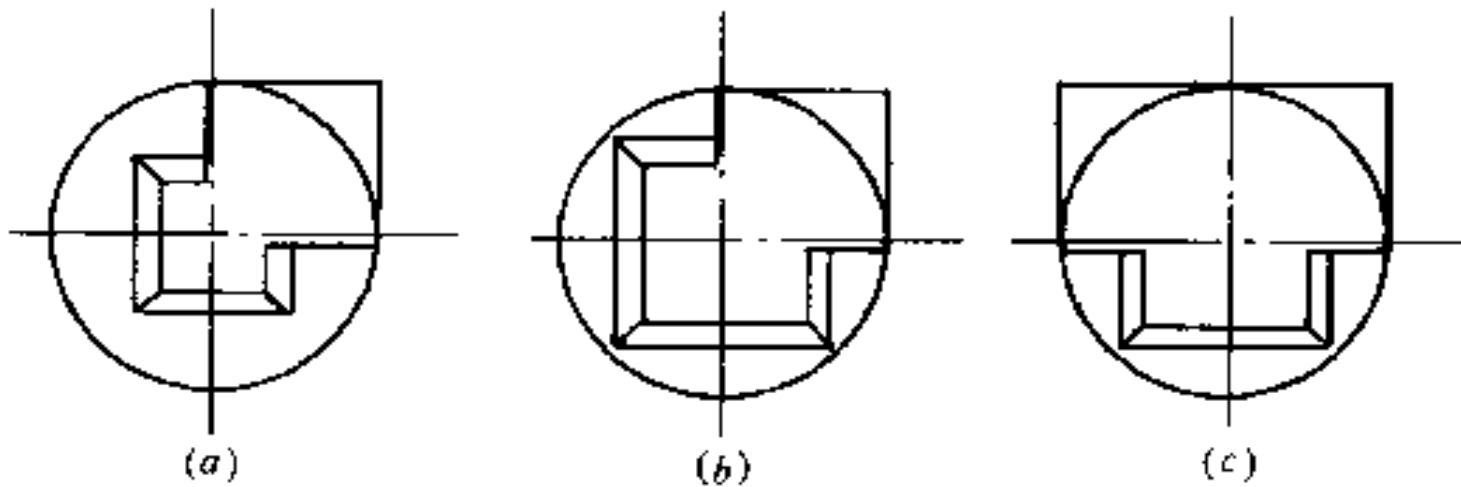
斗拱处钢筋混凝土柱截面(柱径 6 斗口)
